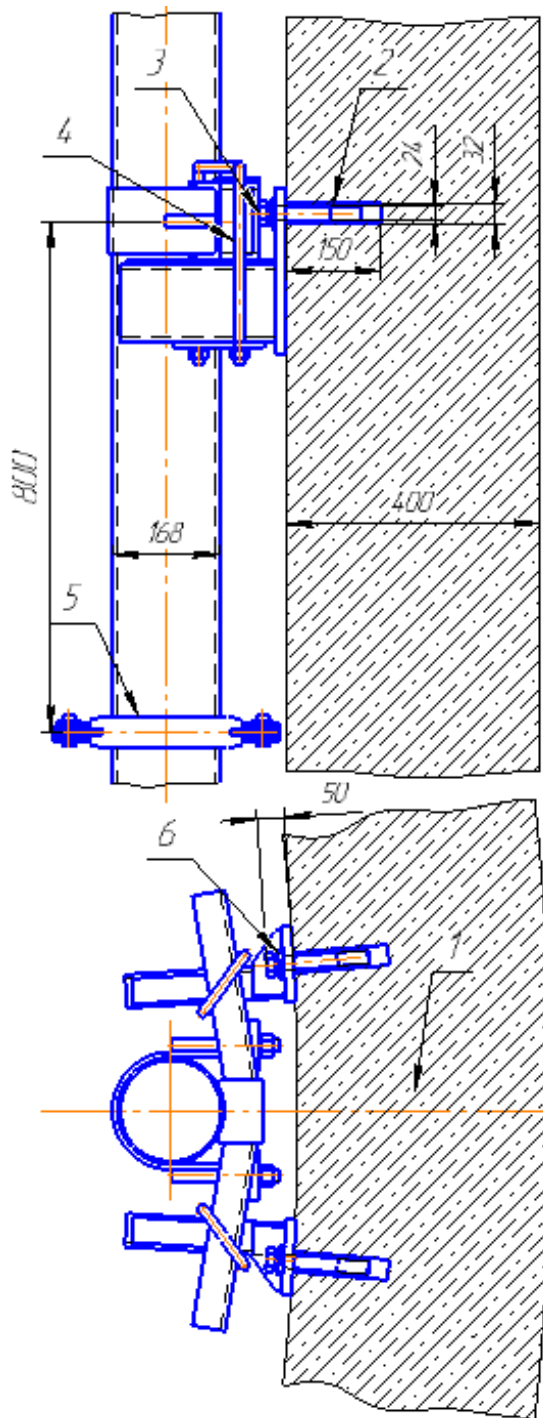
Крепление труб подачи бетона к крепи ствола:
